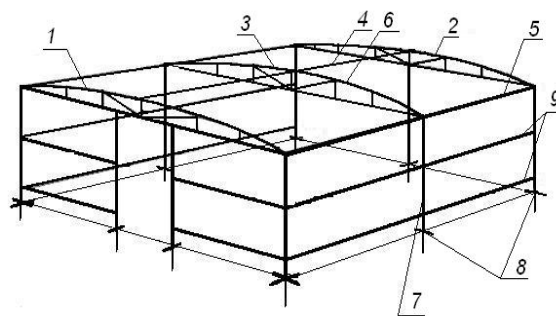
Схема каркаса группового сетчатого изолятора: 1 – ферма торцевая; 2 – ферма задняя; 3 – ферма промежуточная; 4 – коньковые брусья; 5 – распорные брусья; 6 – верхняя часть фермы; 7 – стойка; 8 – направляющий штырь опоры; 9 – брусья.
